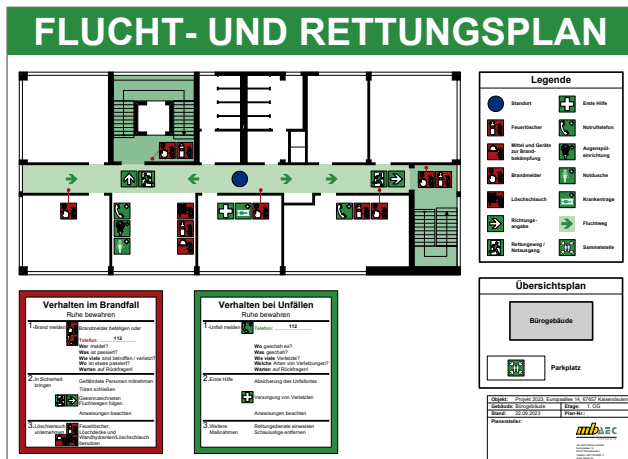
Flucht- und Rettungsplan erstellt mit VICADo.flucht+rettung
